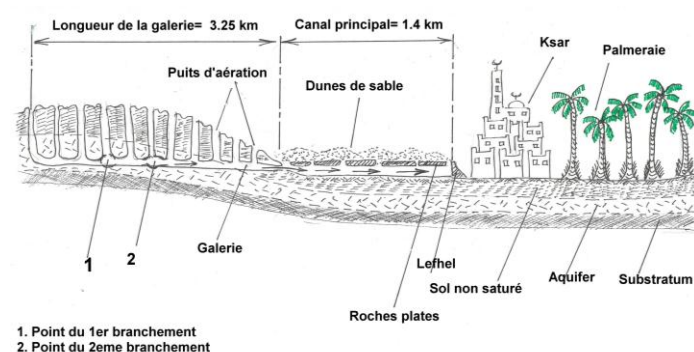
Schéma de la coupe longitudinale de la foggara Ejrida (Remini, 2016)
